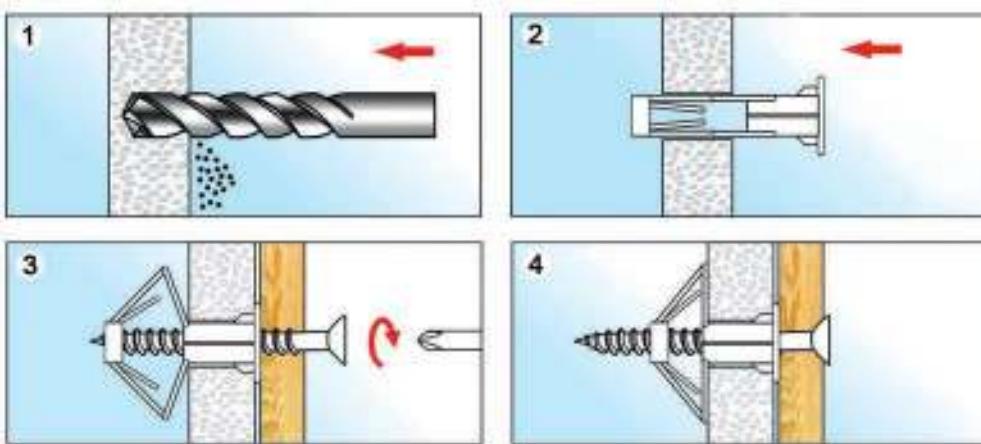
Мацаванне анкернага балта ў бетоннай сцяне
